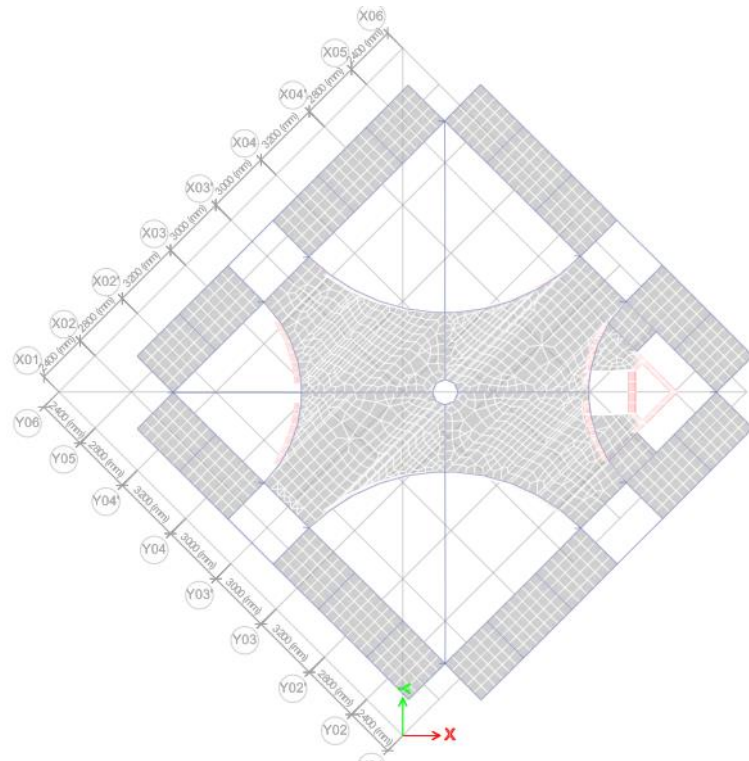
Vista en planta deformada nivel 5 (Modo 1)
